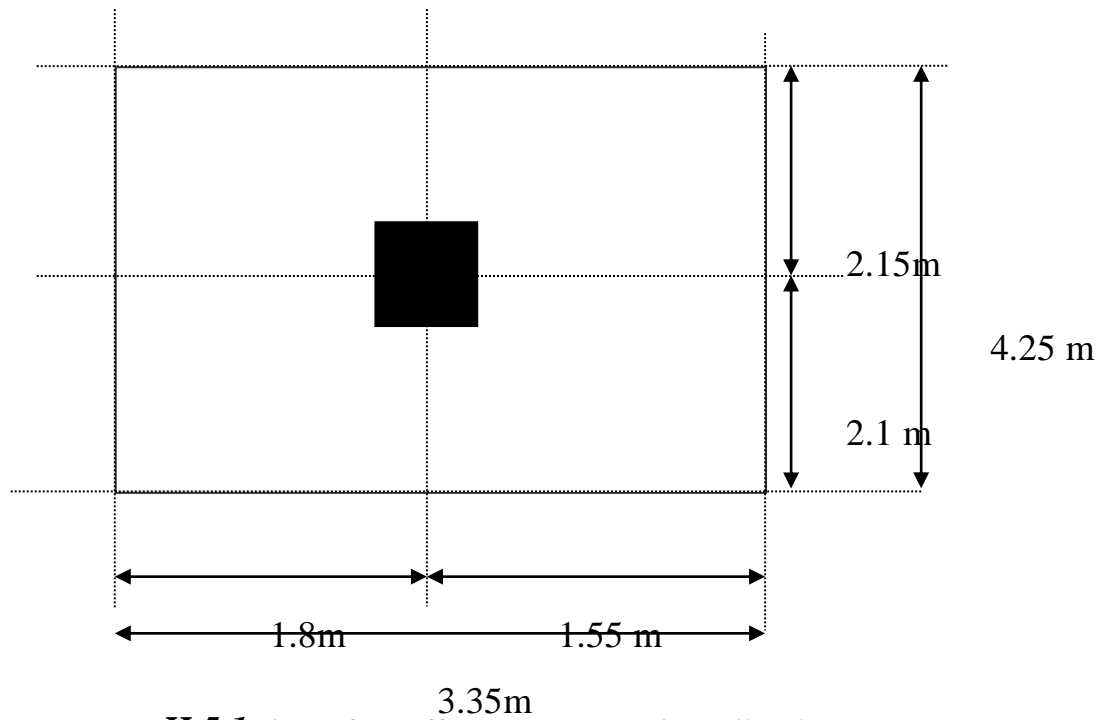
la surface offerte au poteau plus sollicitée.
